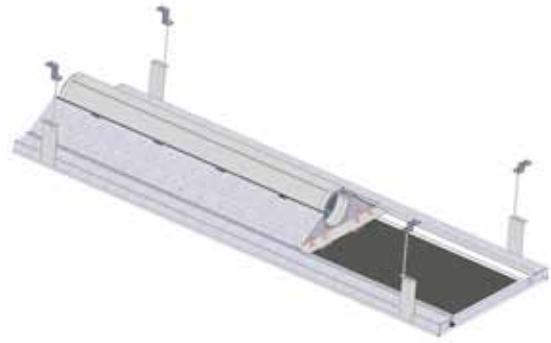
Beispiel einer Aufhängung mit Gewindestange.
